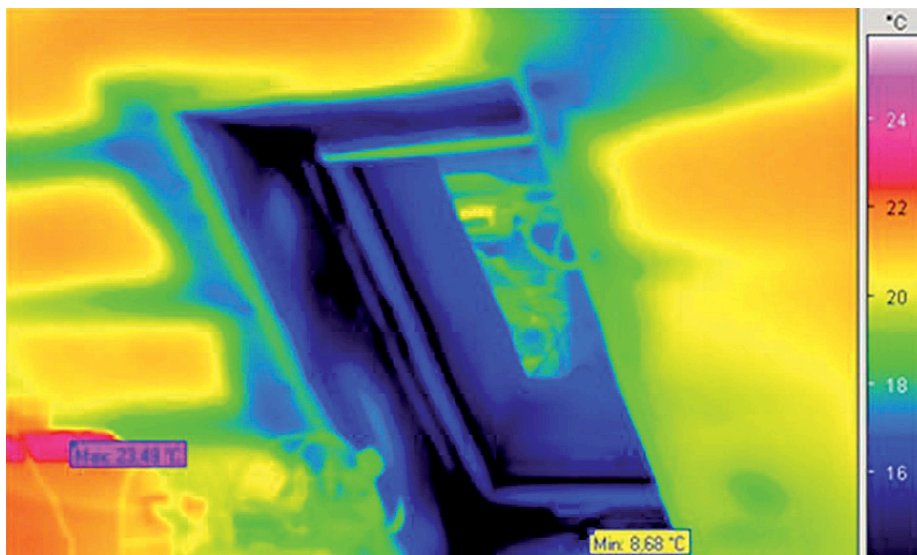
mangelhafter Einbau Dachflächenfenster in einem Wohnraum
